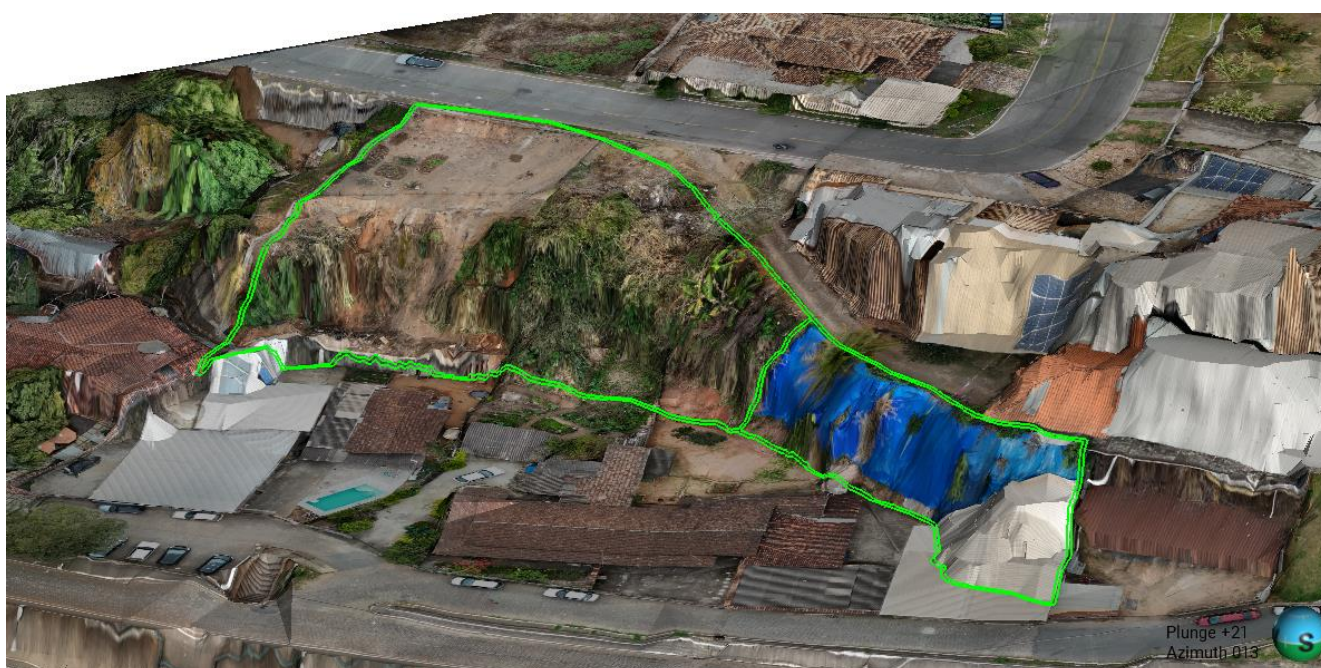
Projeto conceitual proposto para as canaletas locais.
